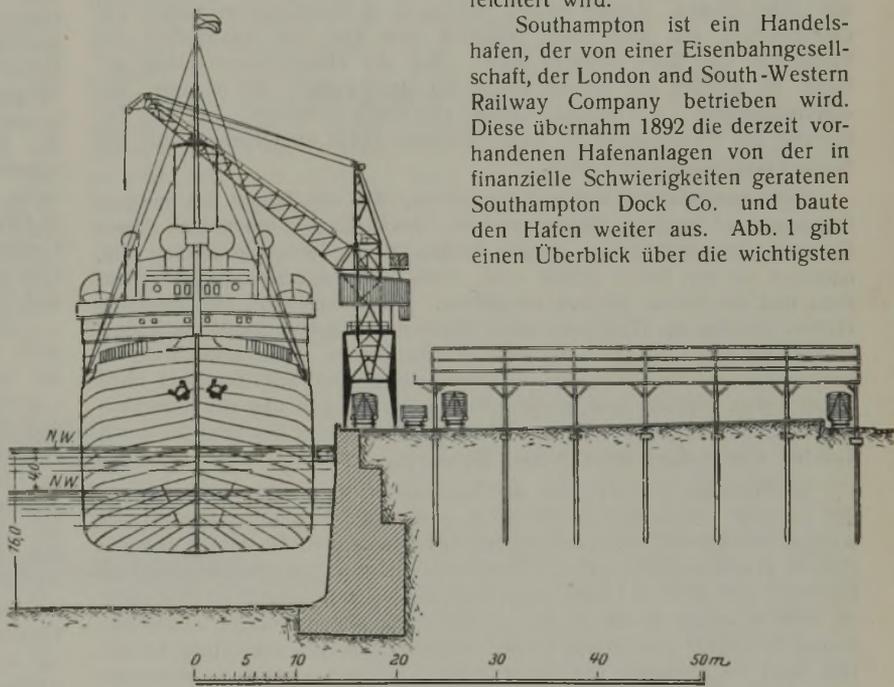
Querschnitt durch einen Kaischuppen in Southampton.
